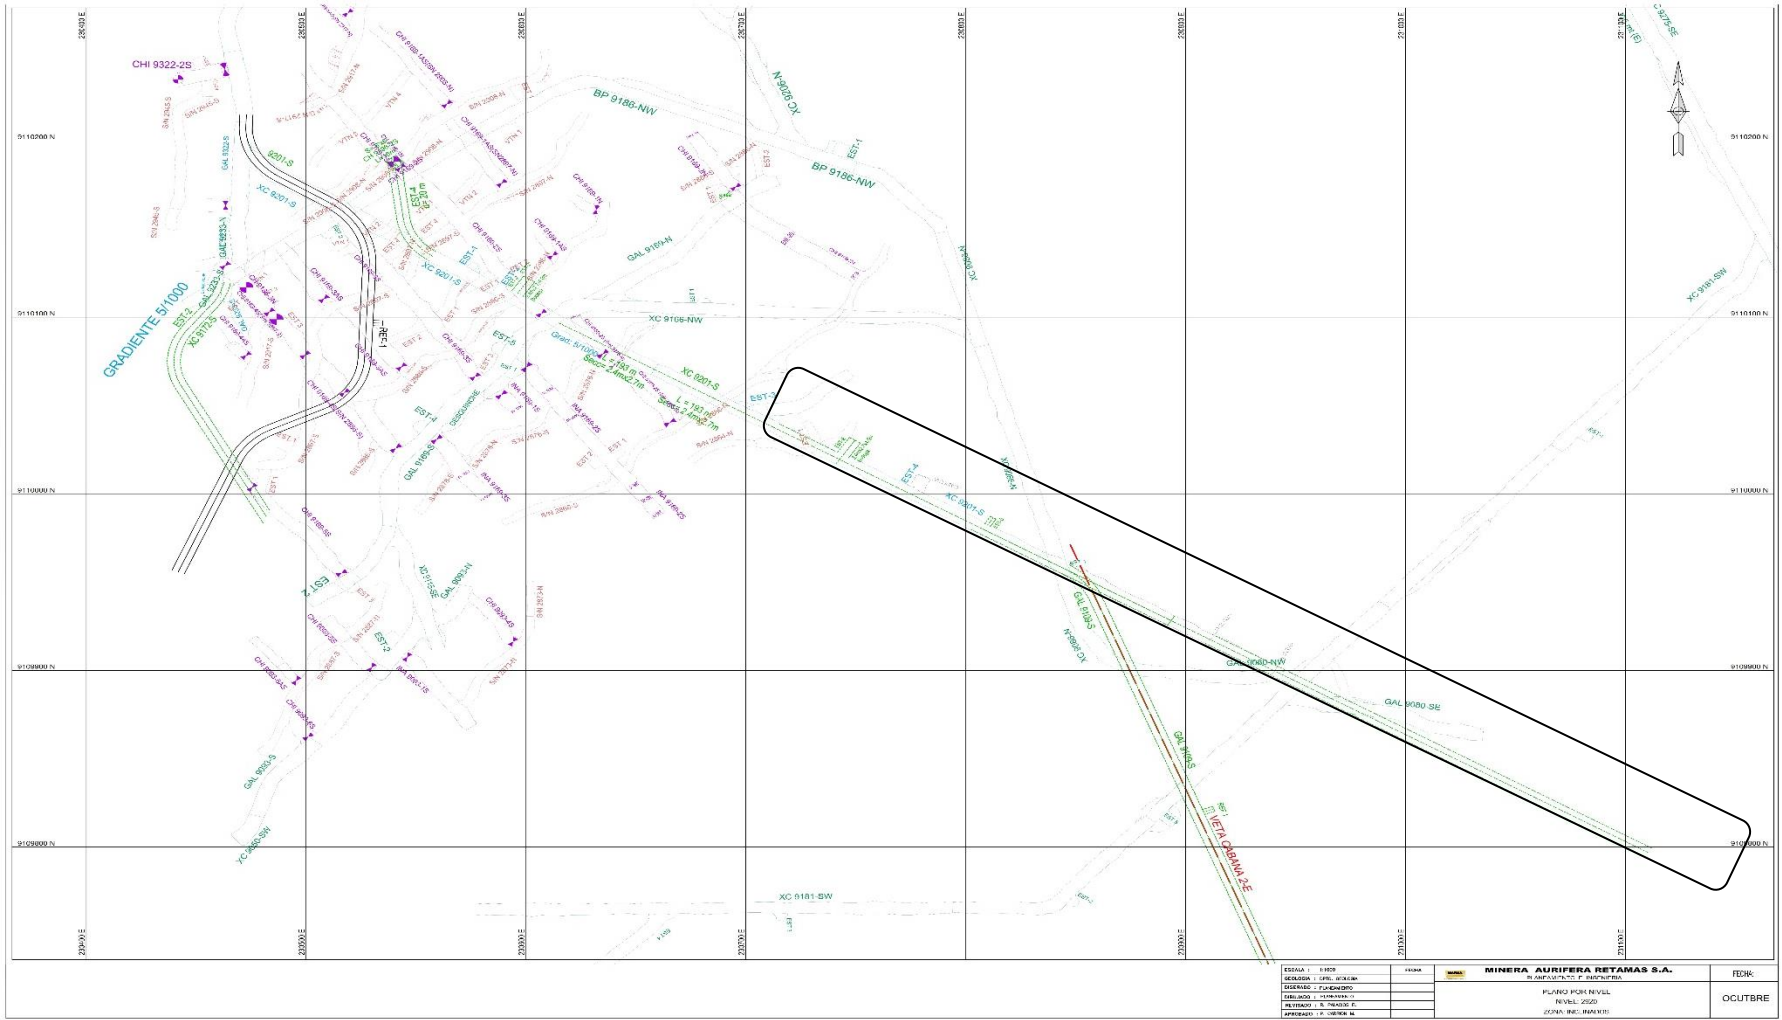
Plano longitudinal de la extensión de la galería principal 9080-SW
